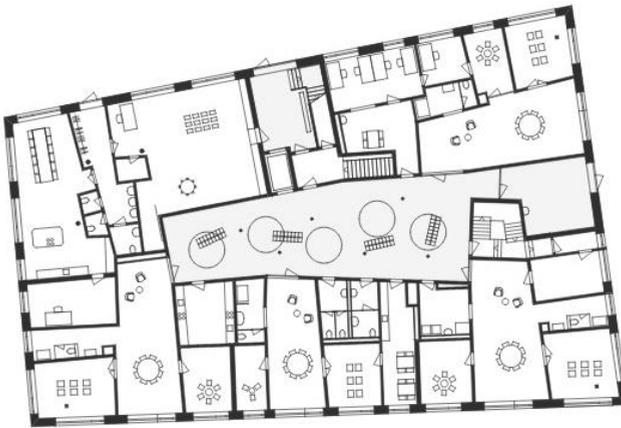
Plan du rez-de-chaussée du bâtiment A des logements mixtes
